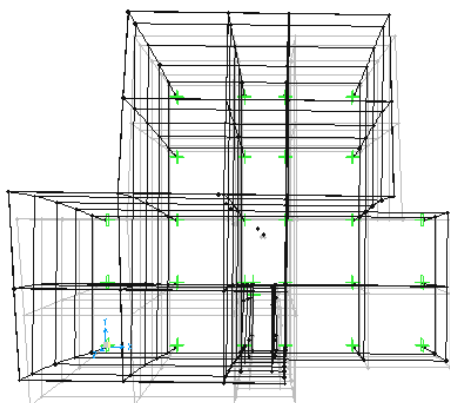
Disposizione in pianta dei dispositivi di isolamento
